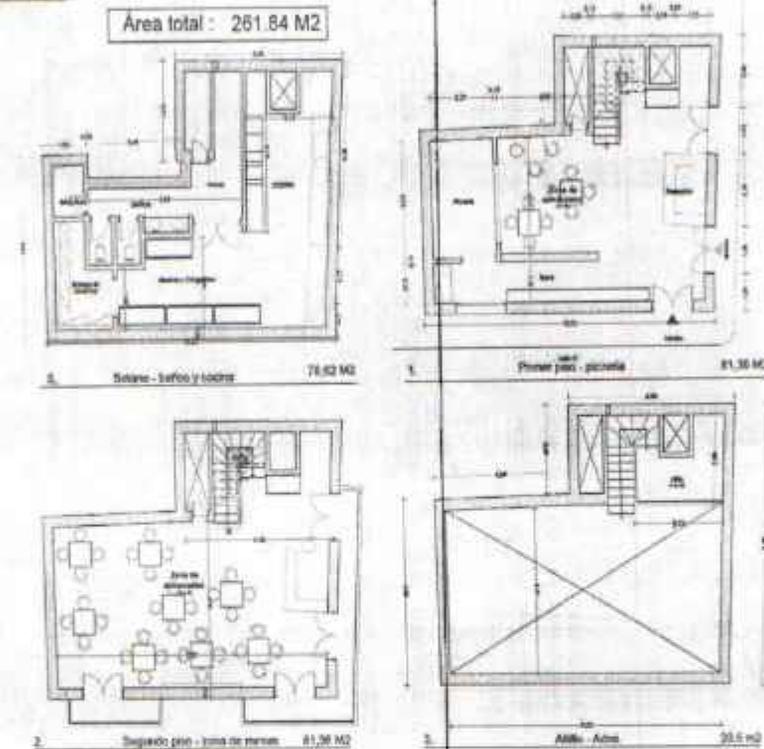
Plano PIZZERIA FERNANDEZ MADRID
